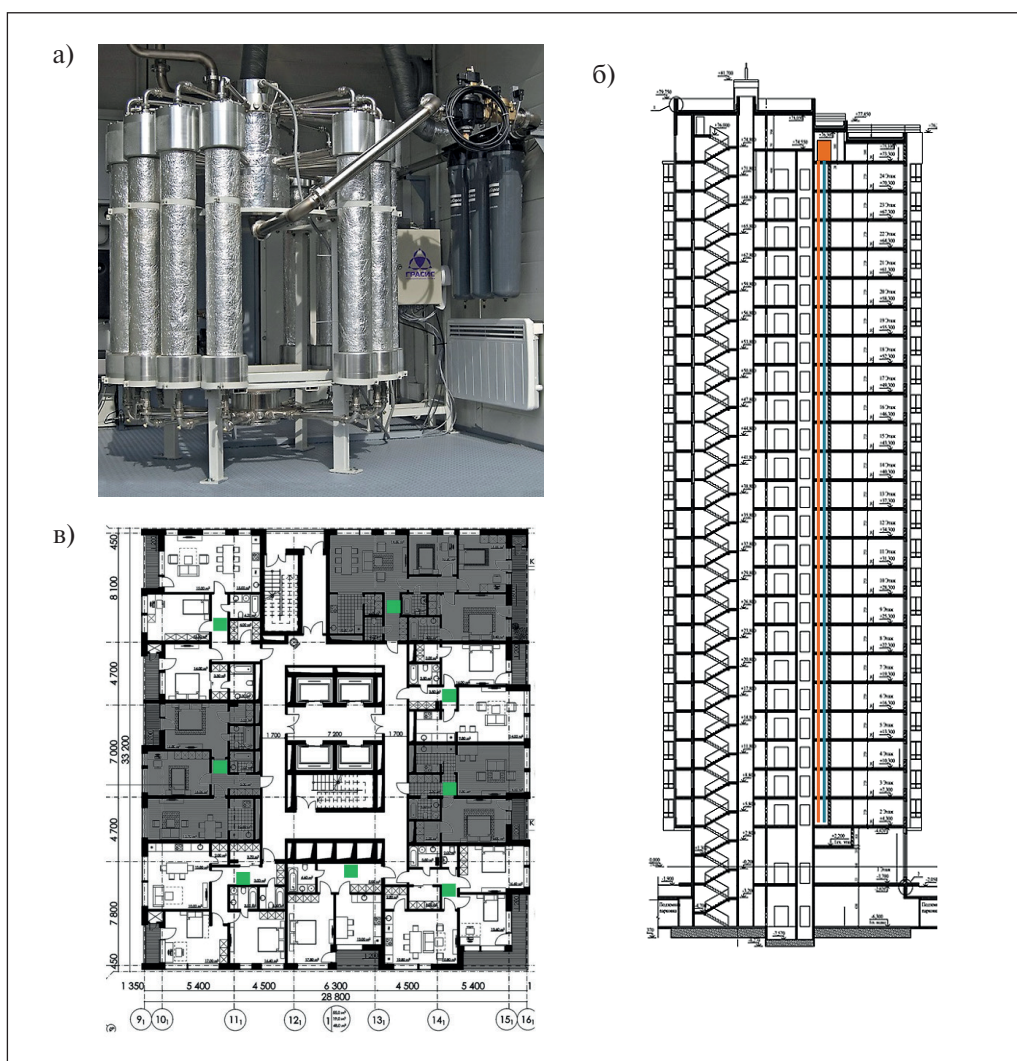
МСВ на техническом этаже (а), разрез высотки с азотным и воздушным трубопроводами (б), планировка этажа с ЭГВСИП (в)
